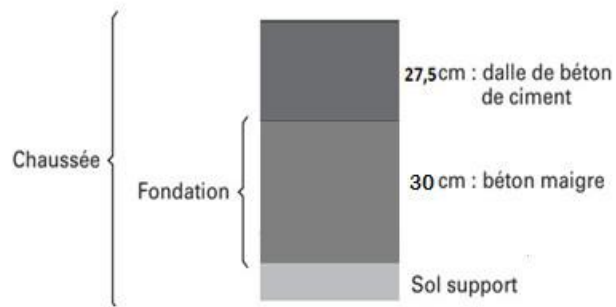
Épaisseur des couches de chaussée rigides pour une zone de post de stationnement.
